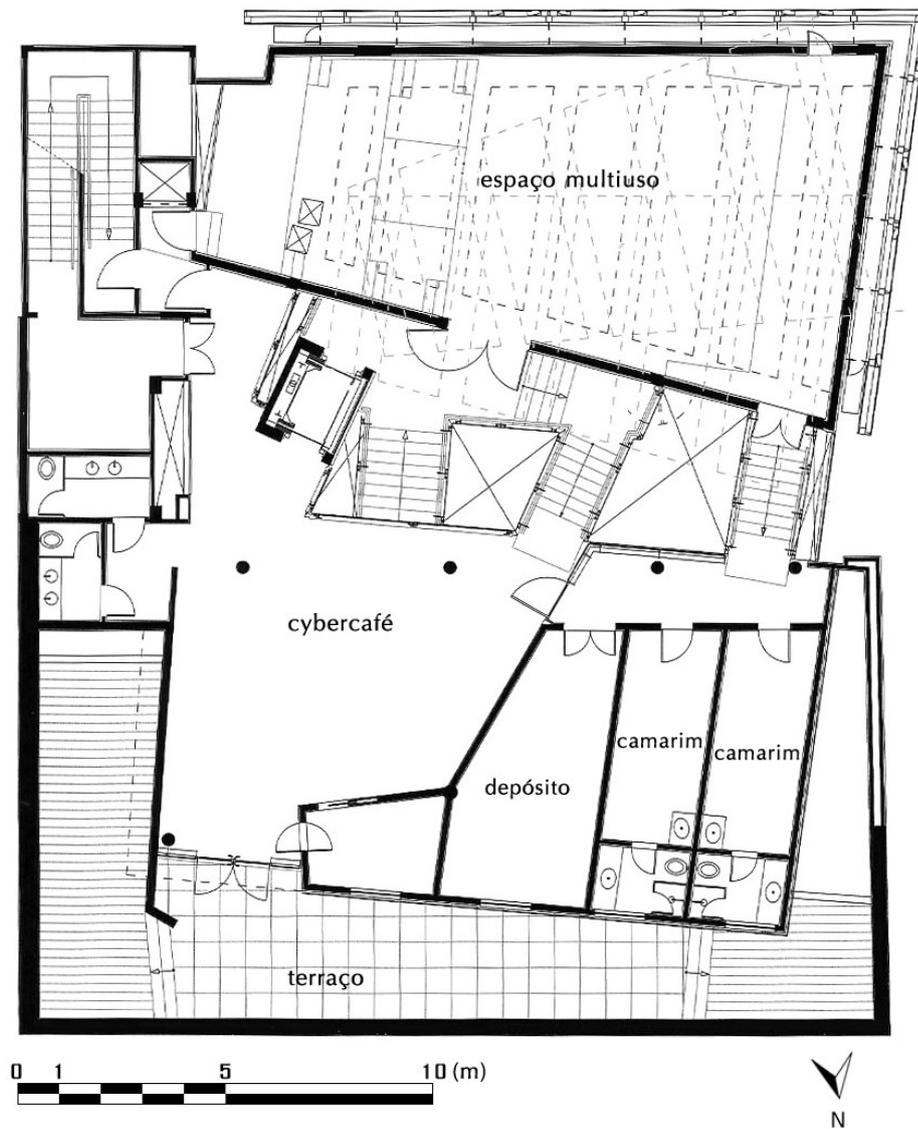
Versão final da planta do quarto pavimento (2005)
